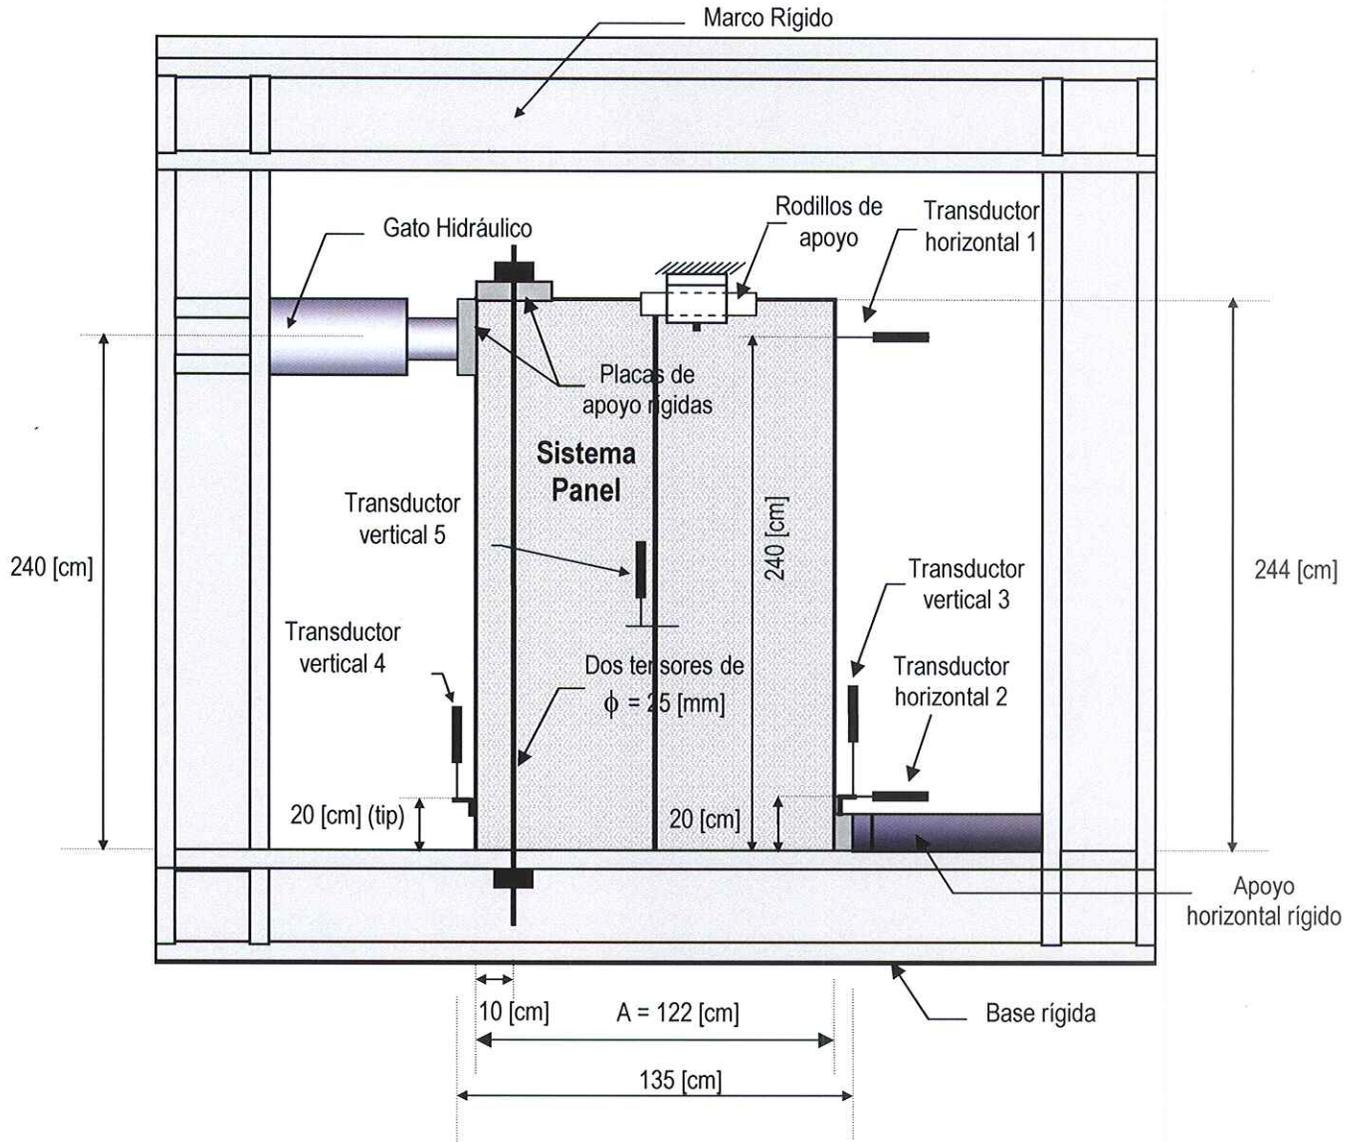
Esquema del ensayo de Carga Horizontal (Corte) de paneles.
